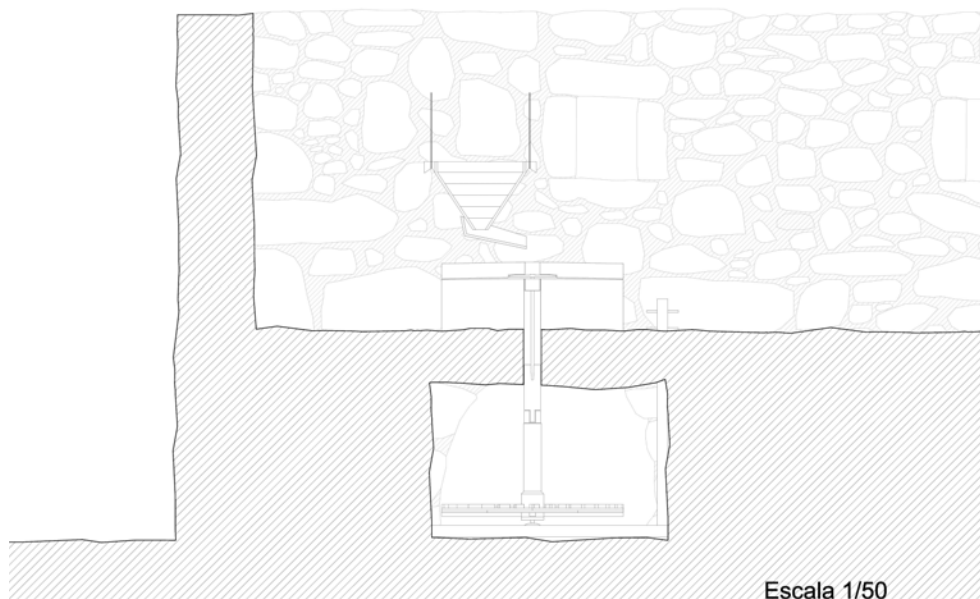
Desenho esquemático de todo o conjunto do mecanismo.
